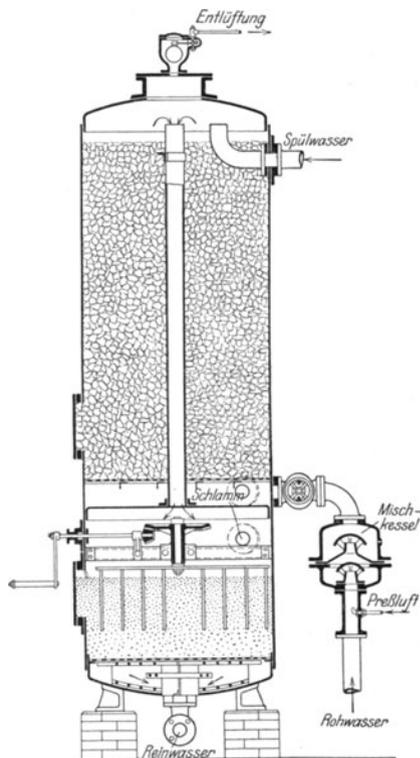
Geschlossene Enteisungsanlage. (Nach Halvor Breda A.-G., Berlin.)
